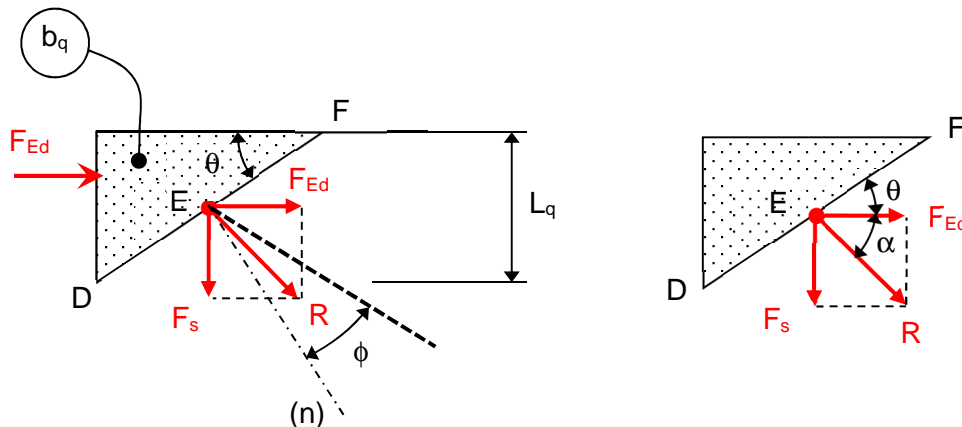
Équilibre du coin assuré par des armatures de couture.
